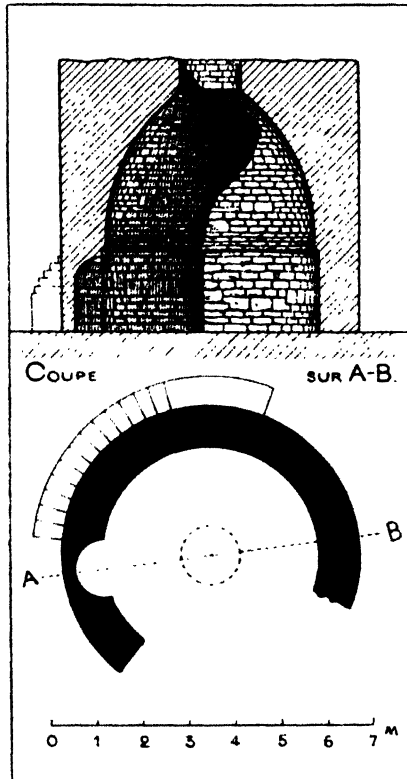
RUINES D'UN VIHARA ROND : PLAN ET ÉLEVATION.
